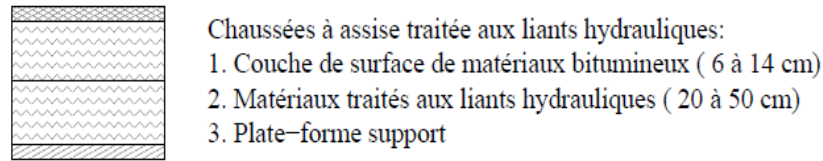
Coupe d'une structure de chaussée à assise traitée aux liants hydrauliques
